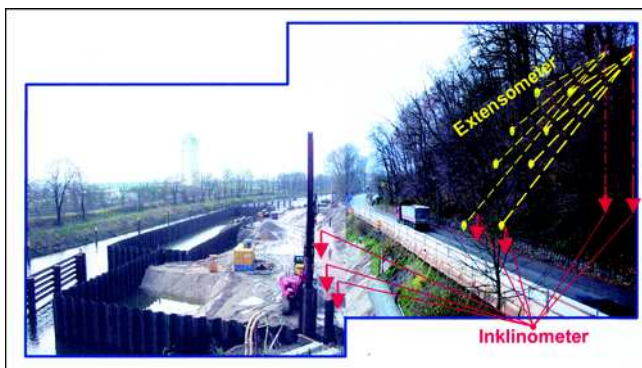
Schleusenbaugrube im Hangbereich mit geotechnischen Messeinrichtungen
